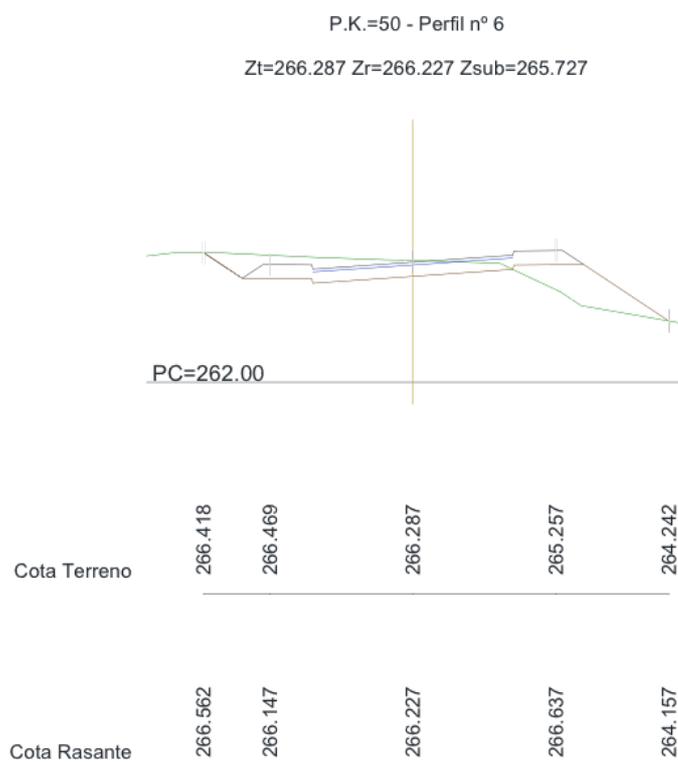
Ejemplo de Perfil Transversal compuesto
